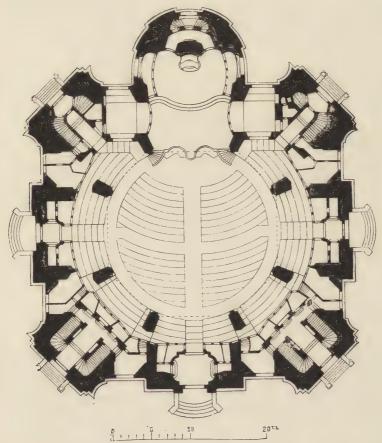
Frauenkirche zu Dresden. Grundriss.
